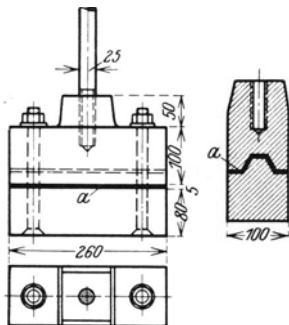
Stampfer für das Rammen der Union-Kanal-dielen.
